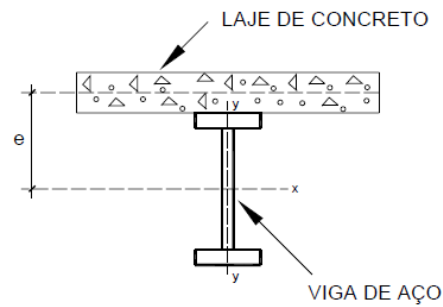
Visualização da excentricidade entre a laje e a viga (Mello,2005)
